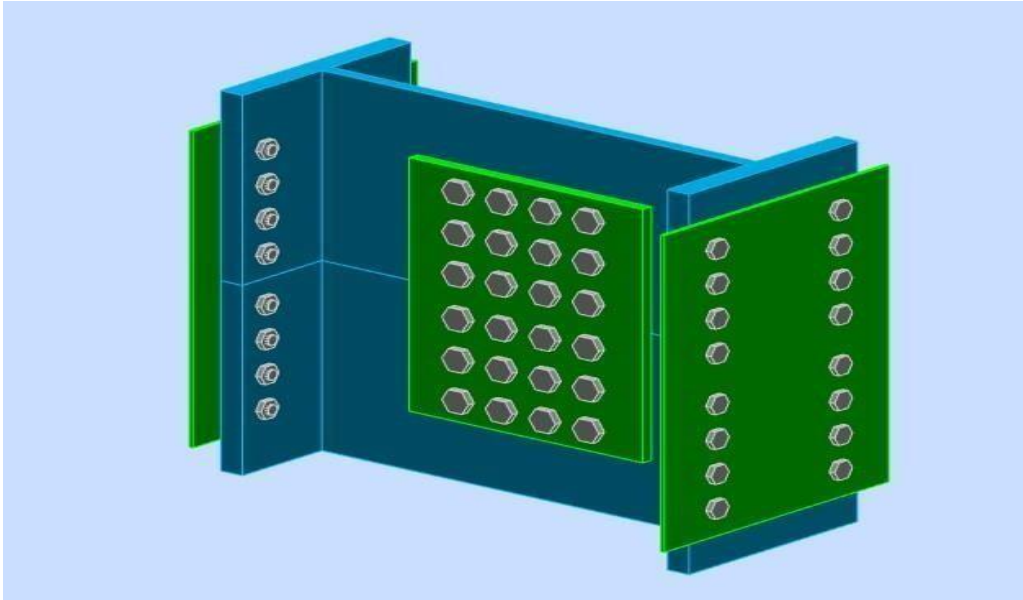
Assemblage Poteaux – Poteaux (HEA300- HEA300).
